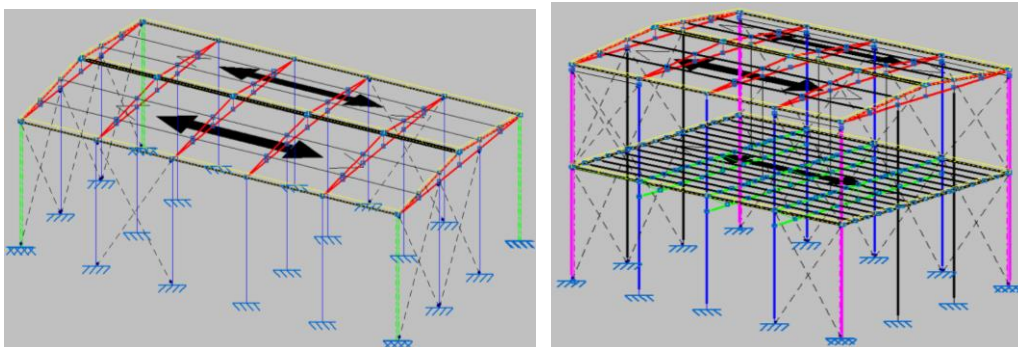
Cargas aplicadas a las estructuras (CYPE 2017)
